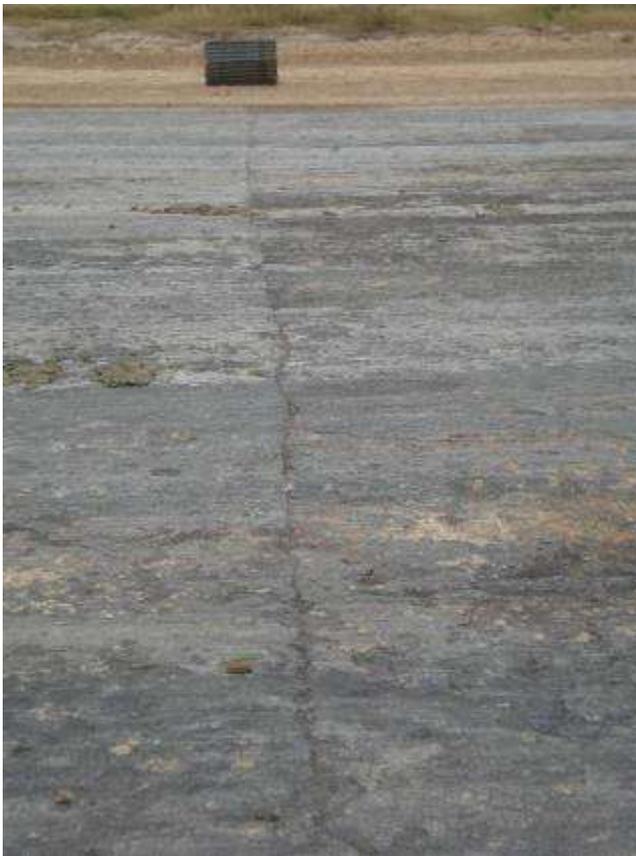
Junta de construcción bien resuelta, se genera un plano vertical bien definido.
